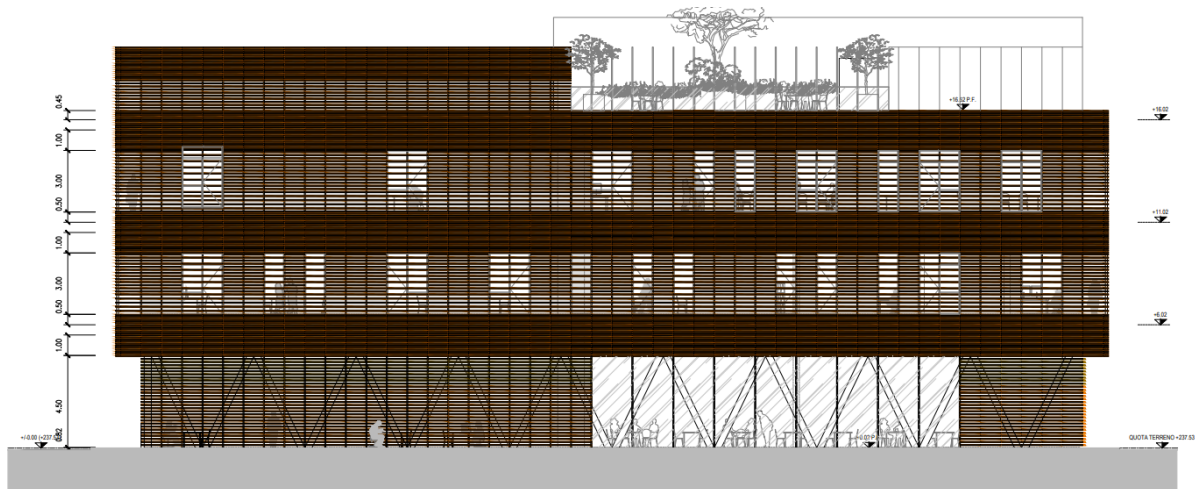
Prospetto deposito/officina Rebaudengo - facciata Est
